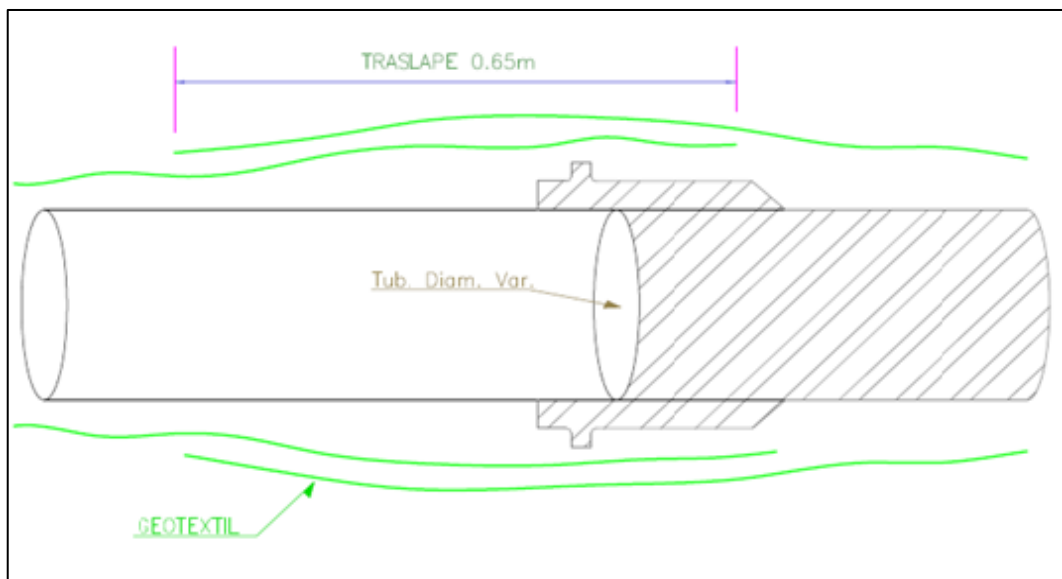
Sección Longitudinal de Dren-Corte-Geotextil
